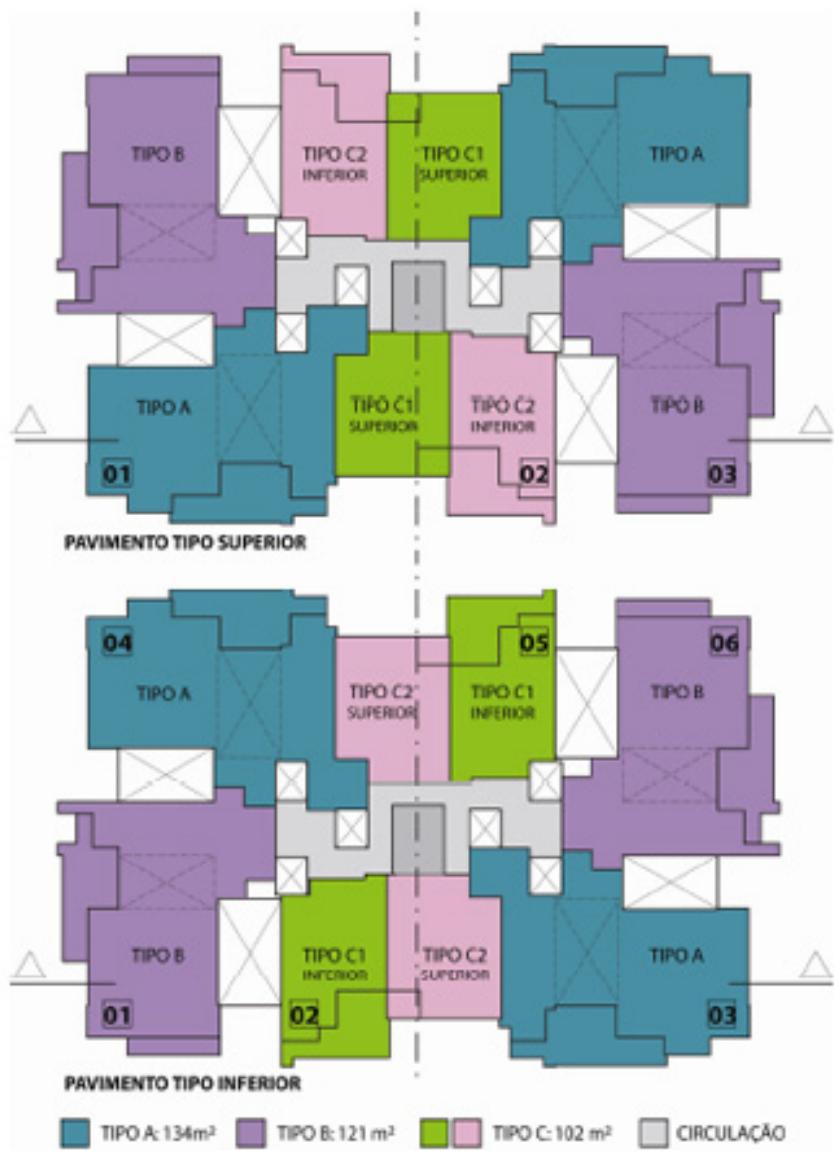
Esquema em planta do pavimento-tipo duplo e dos tipos (sem escala)
